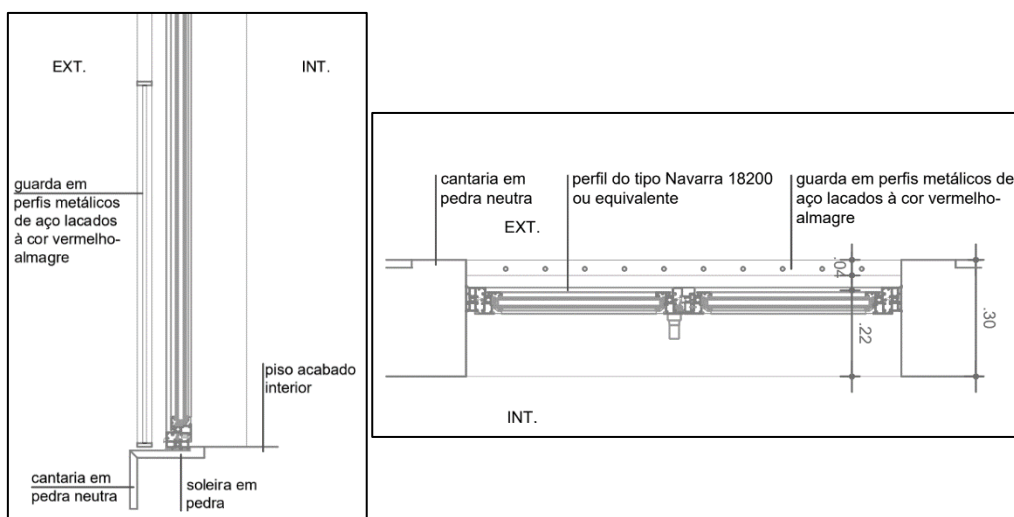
Cortes vertical e horizontal da caixilharia em alumínio
